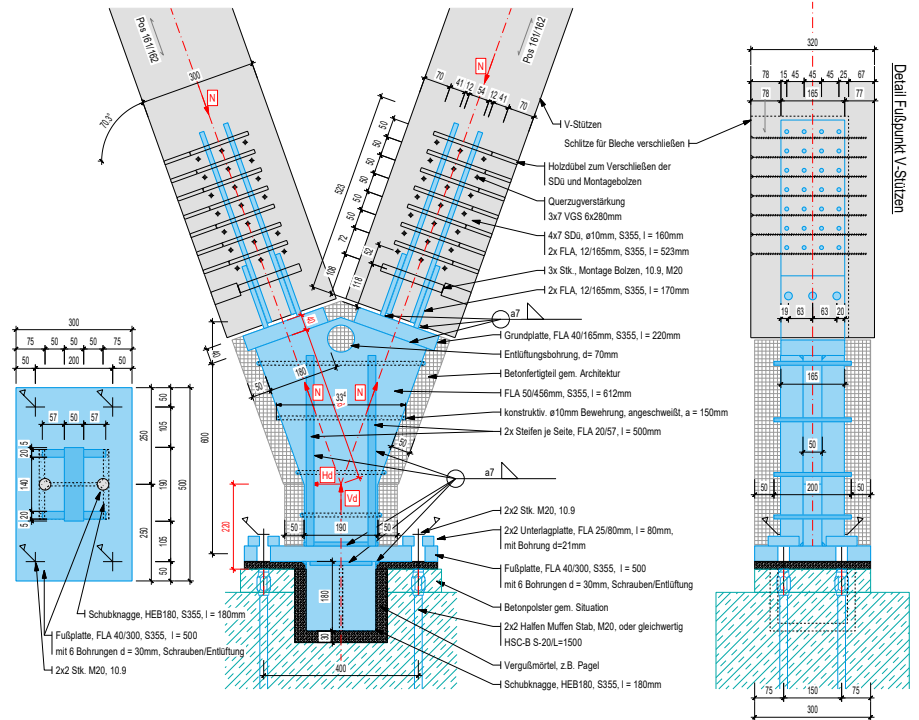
Anschluss-Detail Fußpunkt V-Stützen (Zeichnung: PIRMIN JUNG Deutschland)
